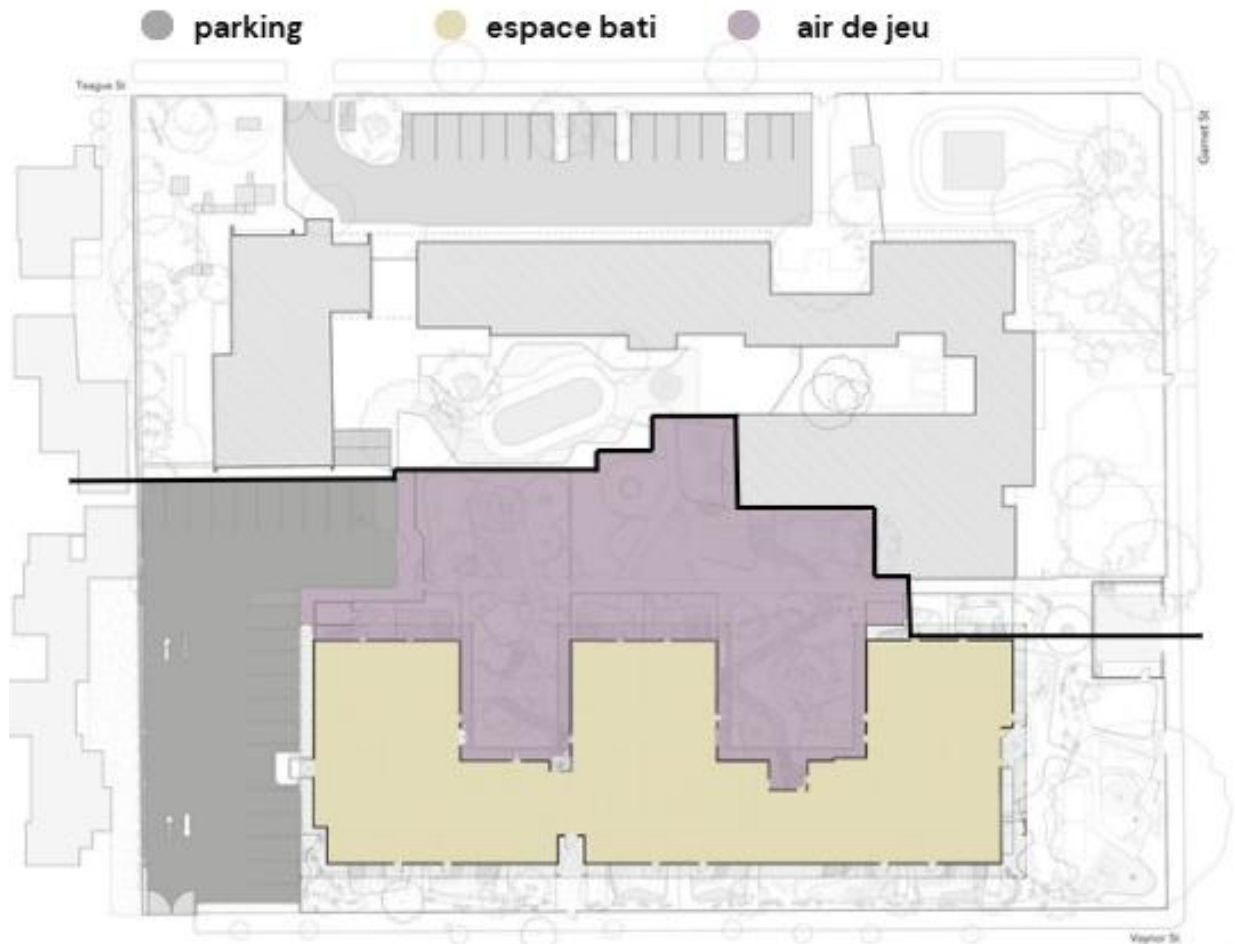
Plan de masse du projet indiquant les zones de parking, espaces bâtis et aires de jeu (source :auteurs d'après ;Guymer Bailey Architects)
